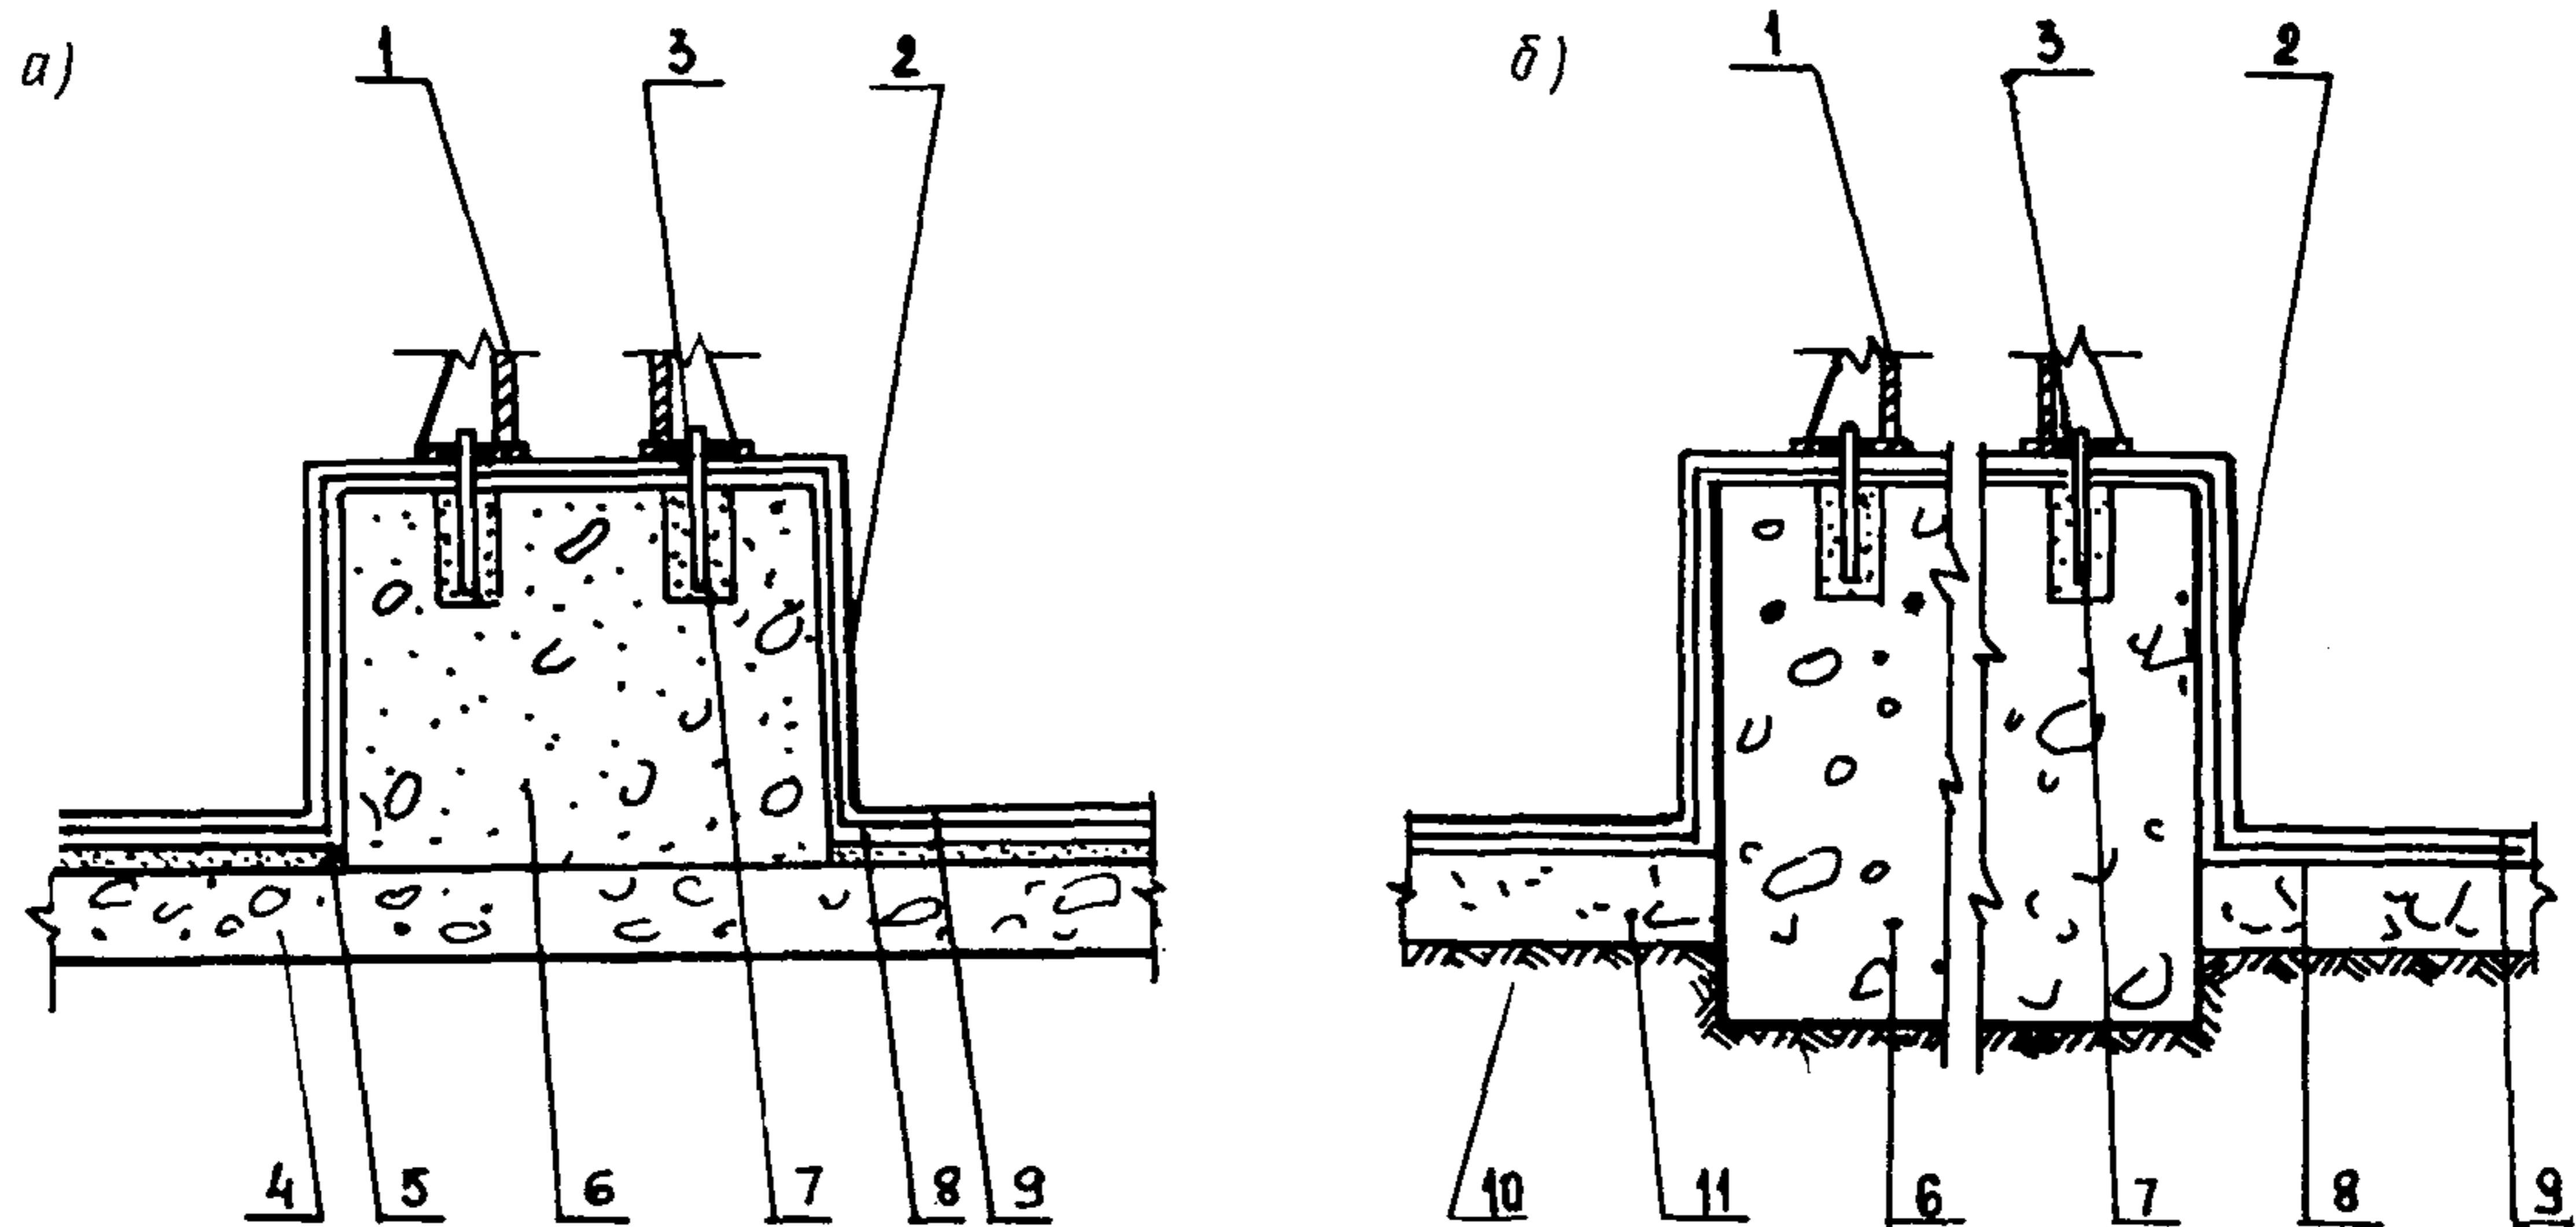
Схема защиты фундаментов под оборудование по перекрытию и на грунте
